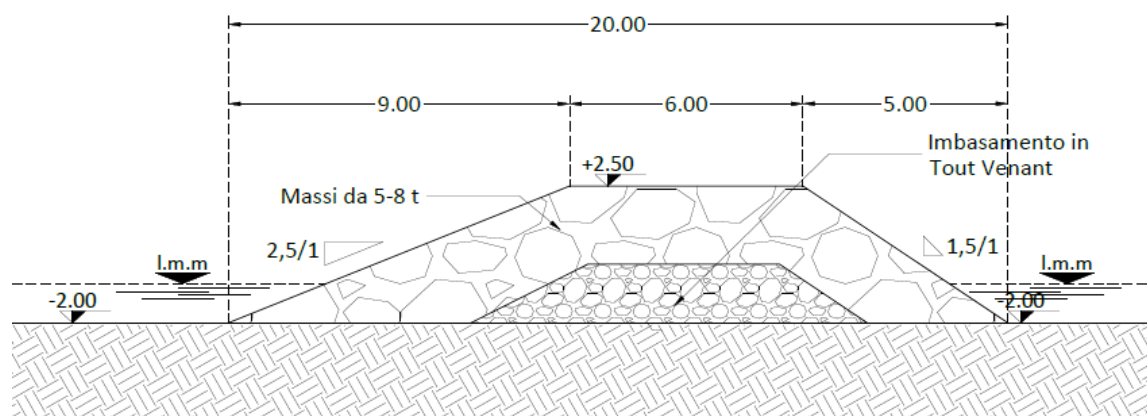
Sezione tipo molo sopraflutto lotto 1
